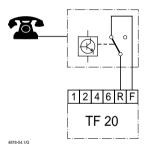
Falls vorhanden: Fernschalter (Zubehör; bauseits) anschließen.
